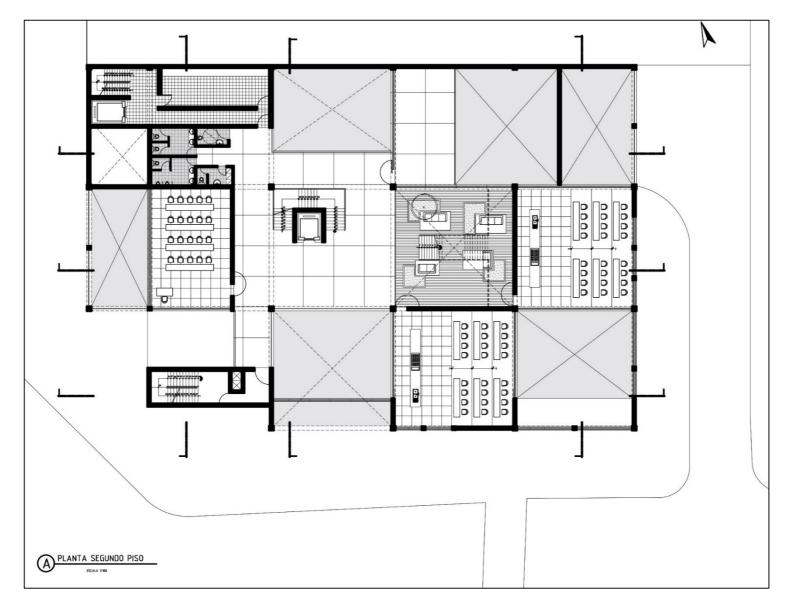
Planta de distribución – Segundo Nivel Fuente: elaboración propia
